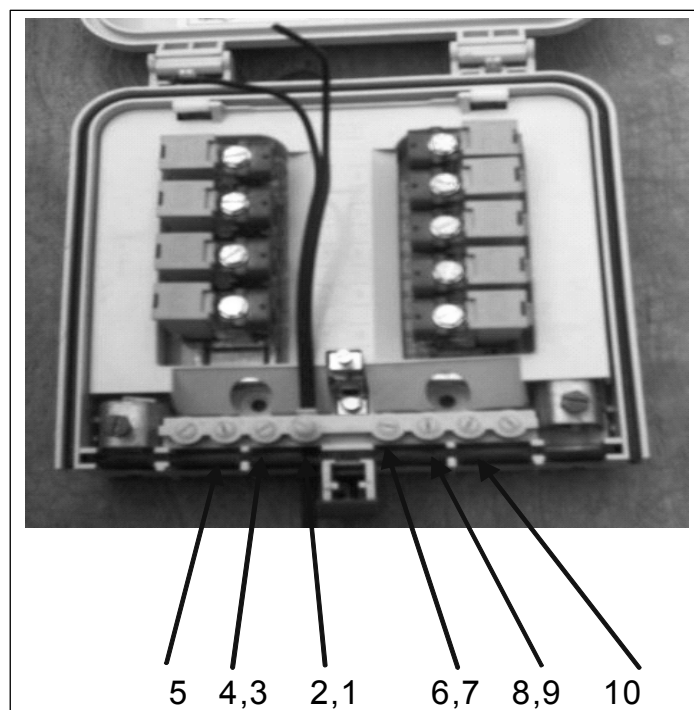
Colocar en Orden los Bajantes en la Terminal de 10 Pares.
